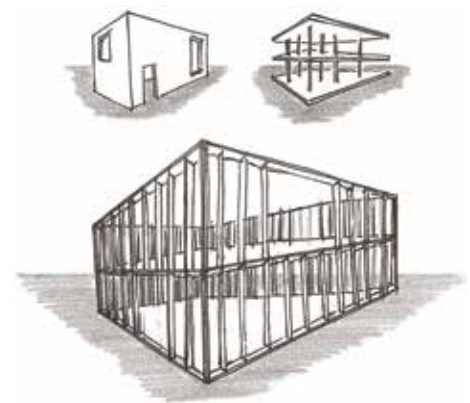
El muro descompuesto se sitúa entre la arquitectura maciza y la ligera
